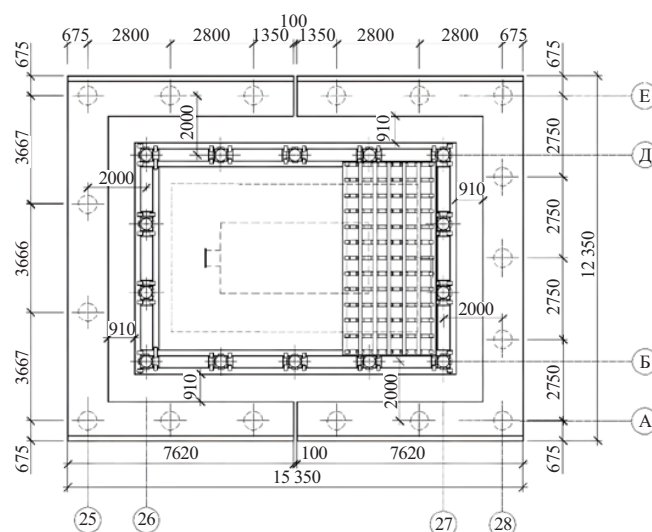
План водоприемного оголовка с защитными железобетонными конструкциями [9]
